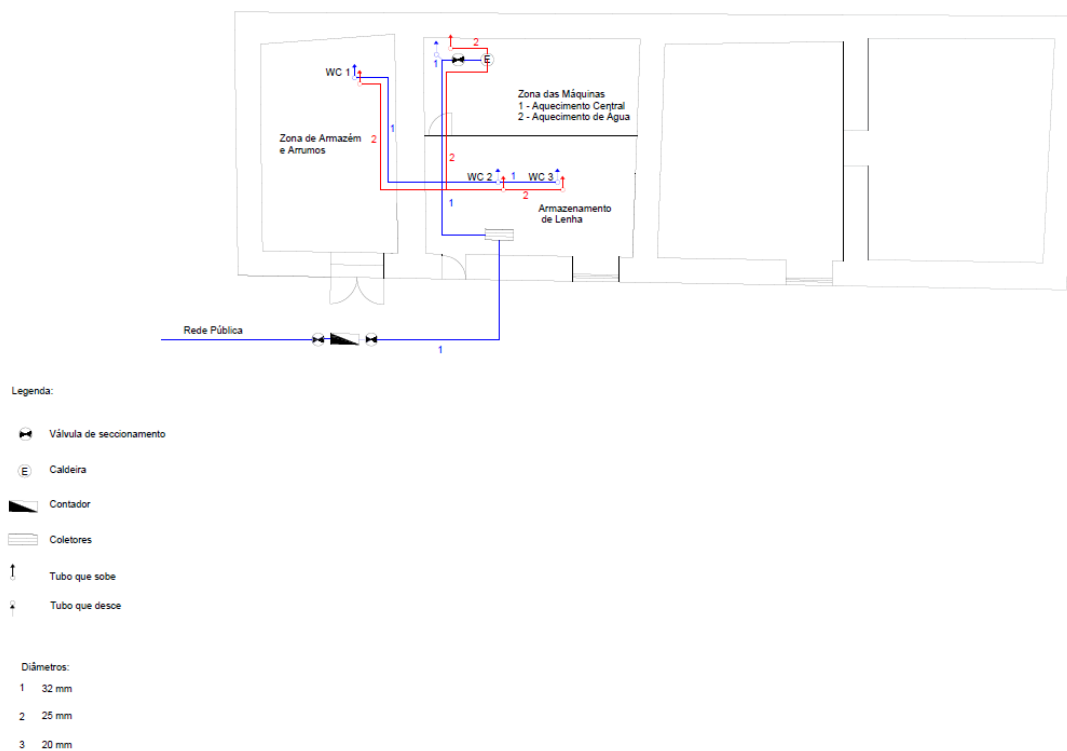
Rede de Abastecimento de Águas – Planta da Cave.
